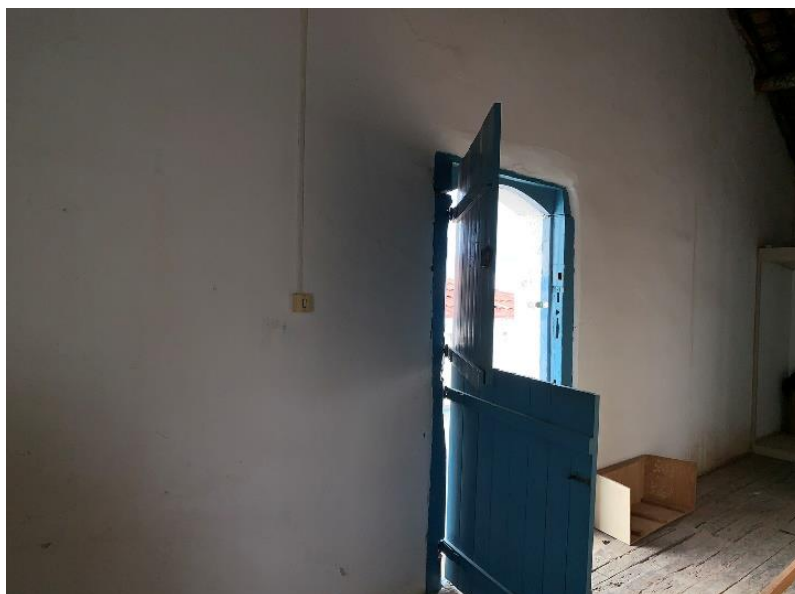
Parede 7, Sala 5 no Pavimento Superior
